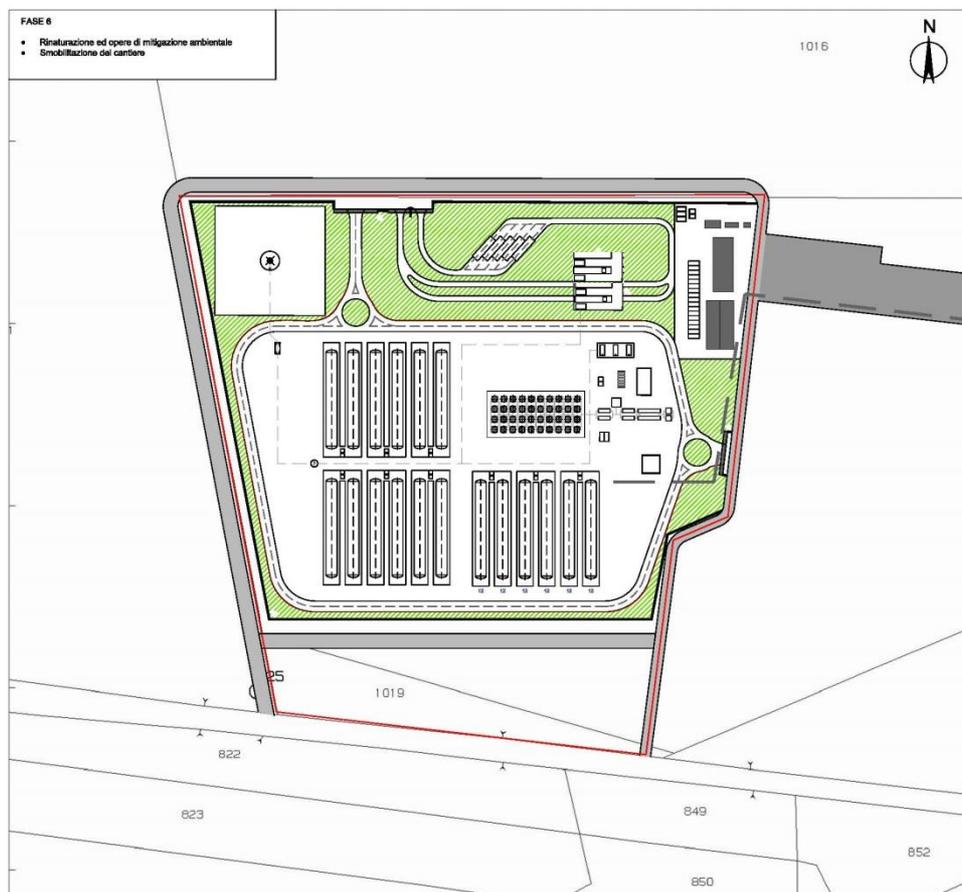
Fase 6. Area oggetto delle lavorazioni previste
